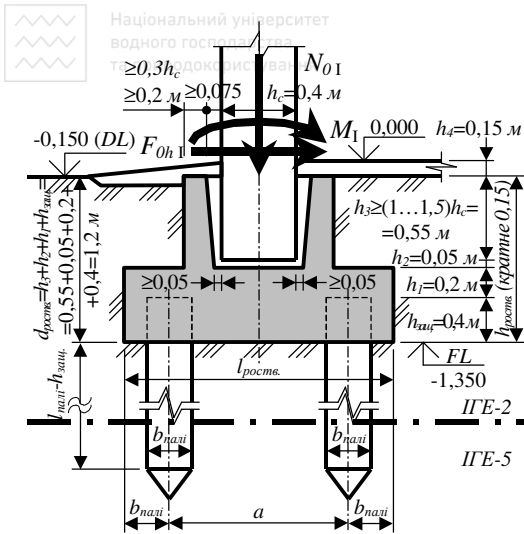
Схема до проектування пального фундаменту під позациентрово навантажену збірну залізобетонну колону та конструювання монолітного залізобетонного стовпчастого типу ростверка: *DL* - позначка поверхні спланованого рельєфу; *FL* - позначка підшови ростверка
